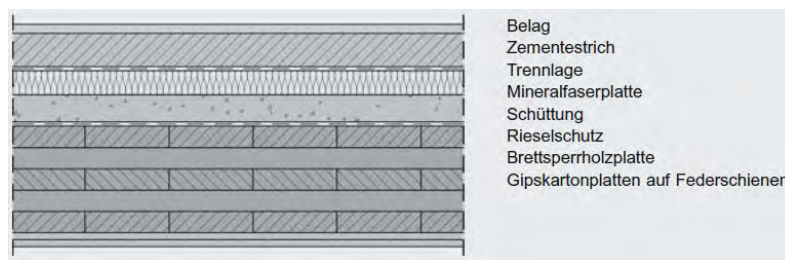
Aufbau einer Brettsperrholzdecke, [32]
